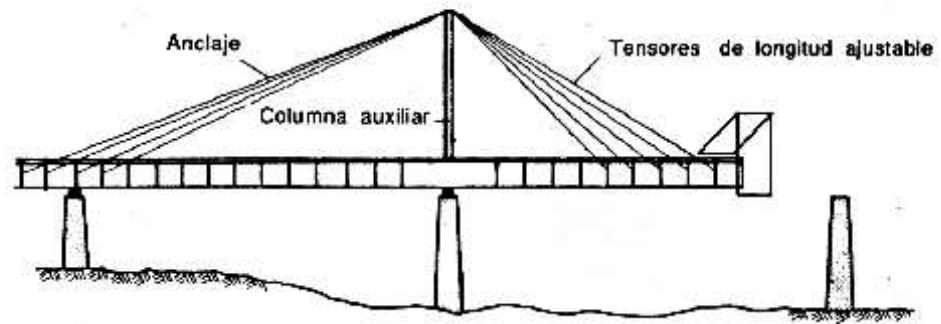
Construcción por voladizos sucesivos con cables inclinados sobre columna auxiliar.
